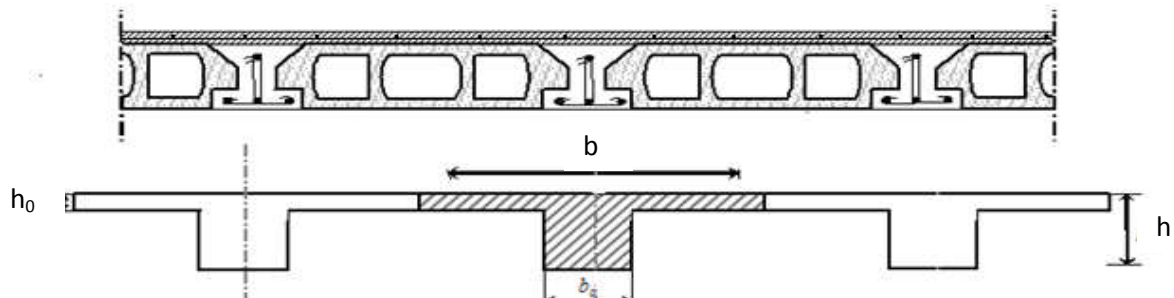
Coupe transversale d'un plancher à corps creux.
